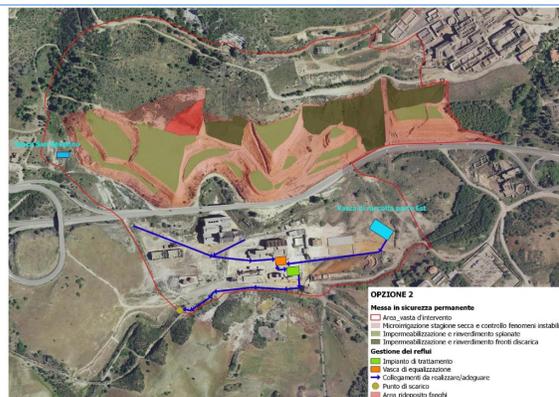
Planimetria degli interventi dell'opzione progettuale n. 2
